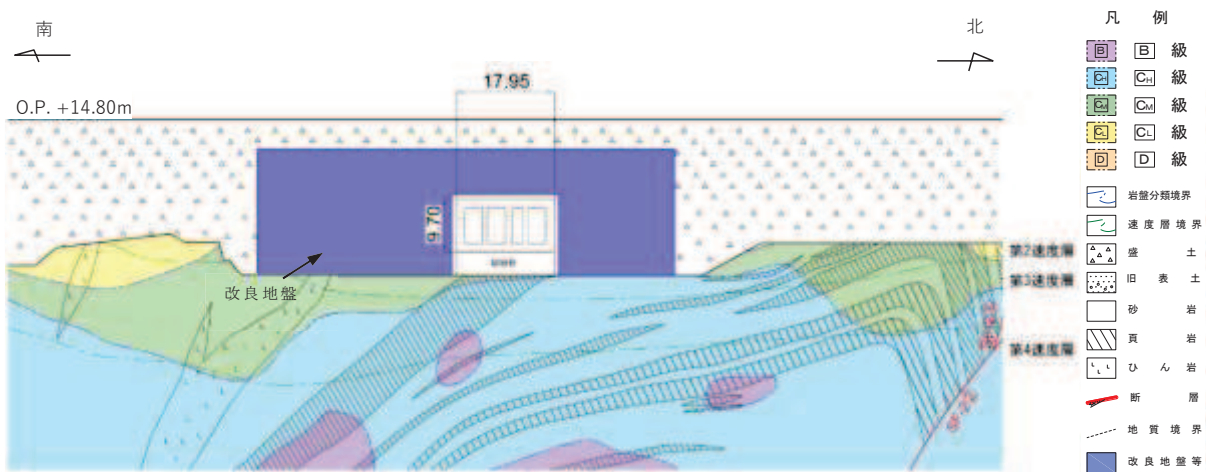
原子炉機器冷却海水配管ダクトの地質断面図 (⑬-⑬断面)
